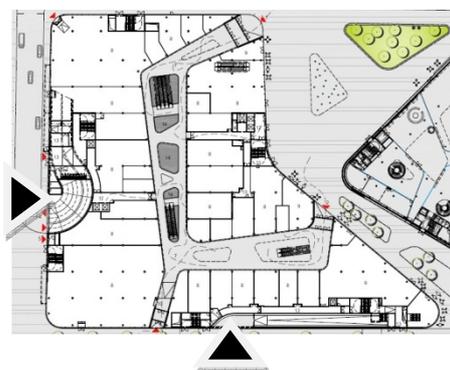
plan d'assemblage de Kulturbau and mall Source : archdaily.com
